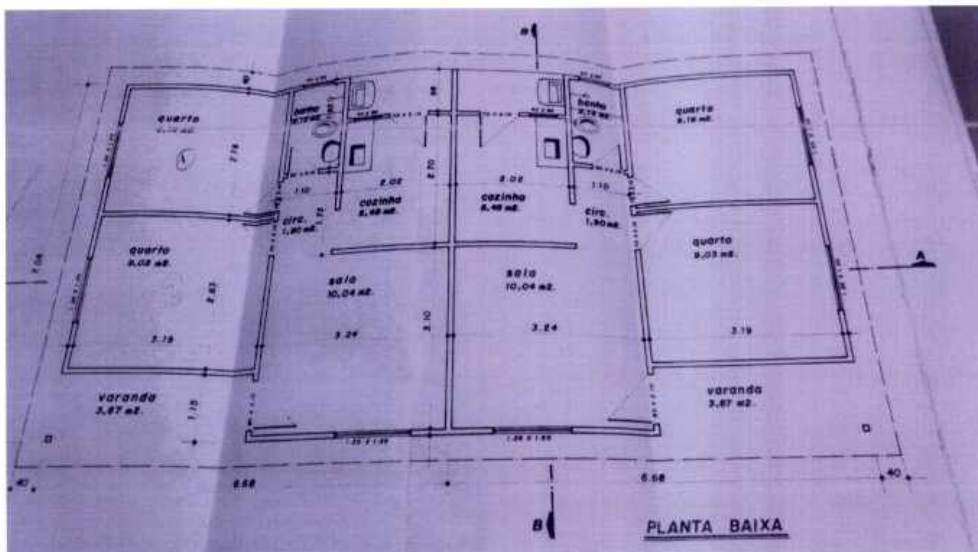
Planta baixa do projeto aprovado (projeto original)
